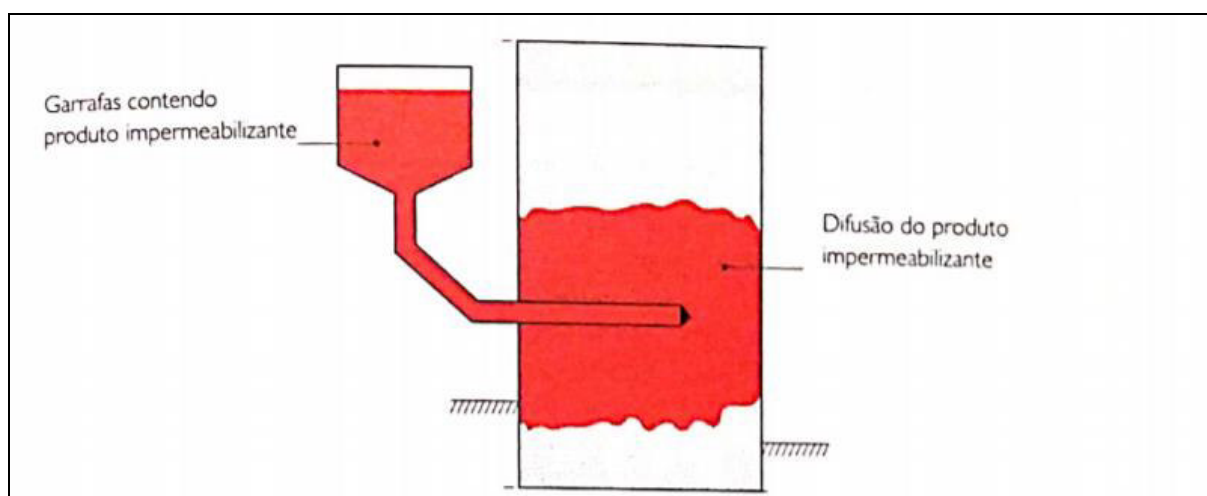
Introdução de camadas impermeabilizantes em alvenaria
